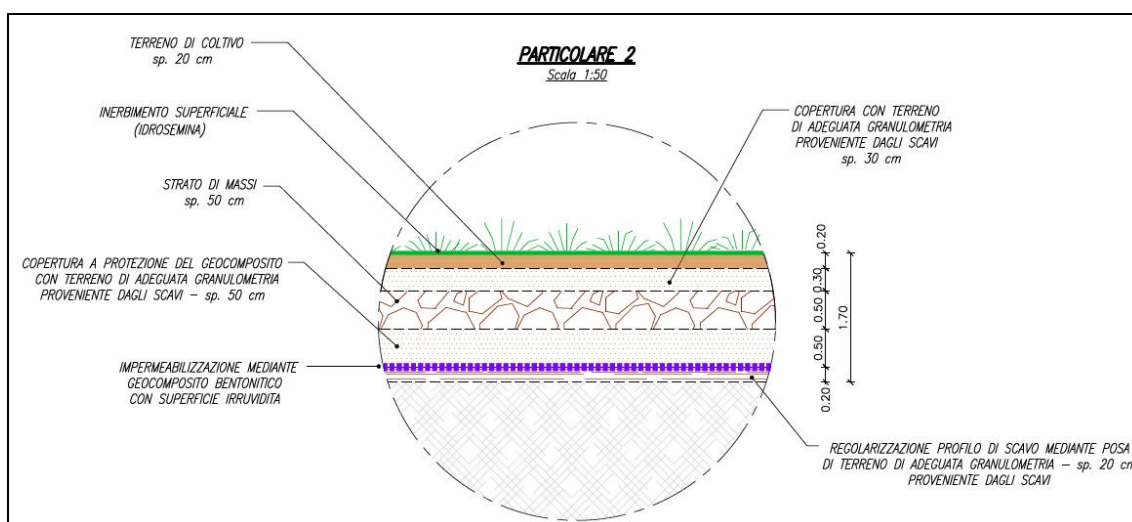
Particolare del sistema di impermeabilizzazione del fondo dell'invaso di laminazione
